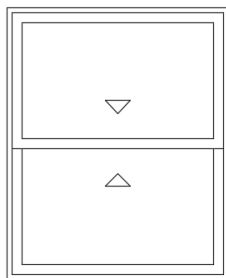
Alçado de vão envidraçado de guilhotina.
